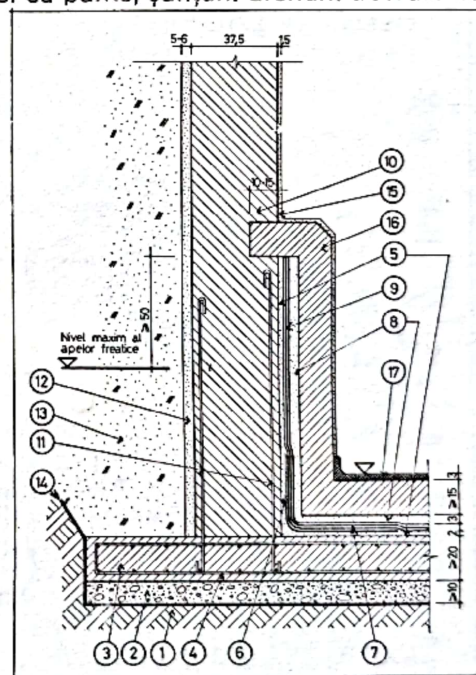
Hidroizolații la un zid exterior, al unei construcții existente, susținut pe fundație radier; presiunea hidrostatică se exercită din exterior; hidroizolația verticală este aplicată la interiorul elementului portant. Secțiune transversală:
